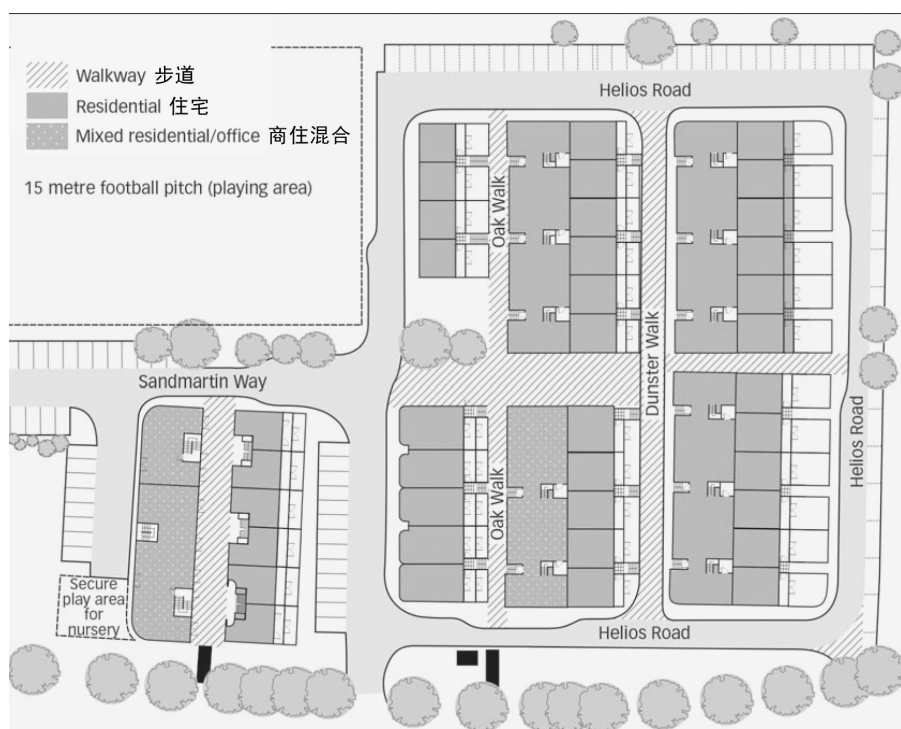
贝丁顿社区项目总平面/ Masterplan of BedZED
